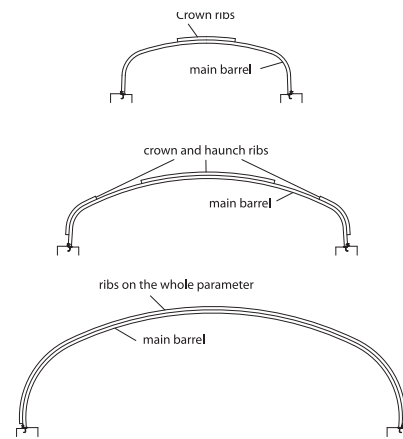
Dispunerea rigidizărilor în secțiune transversală
